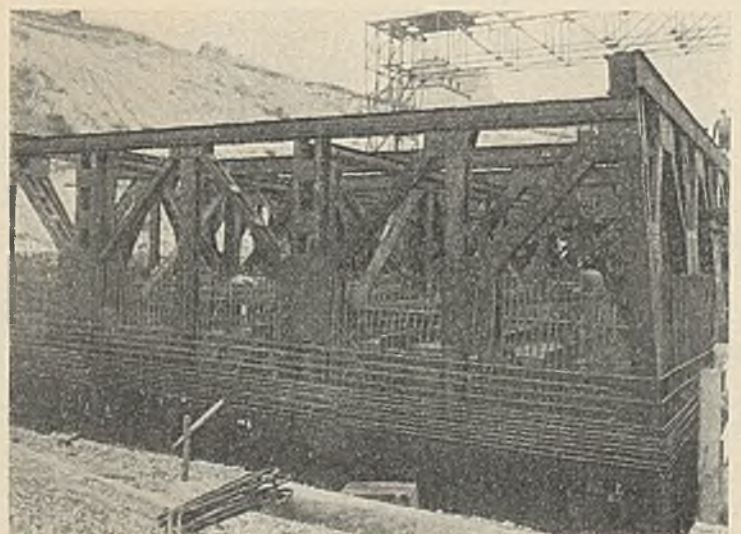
Stahlgerippe sowie Rundeisenbewehrung der Schneiden und der Decke des Senkkastenarbeitsraumes.
